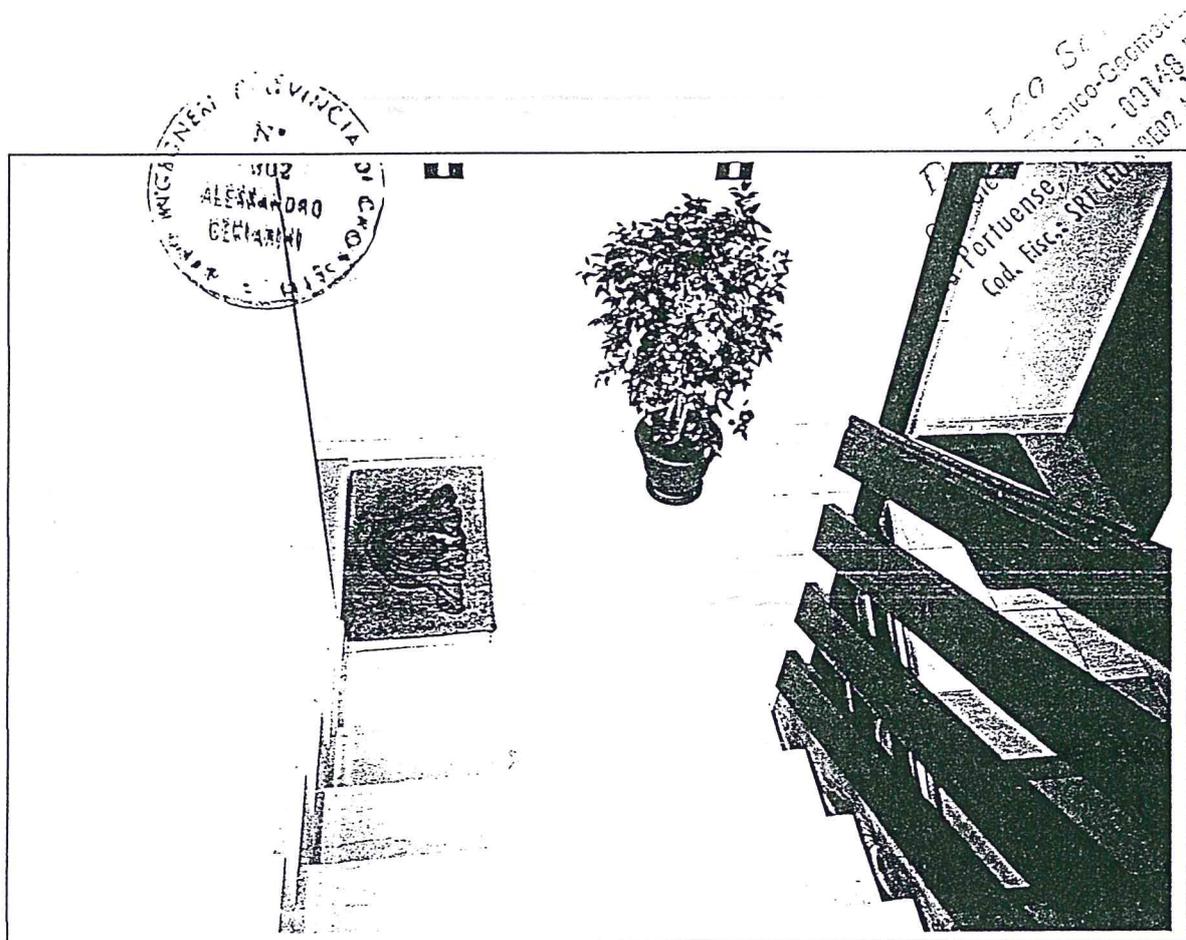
Pianerottolo delle scale con dettaglio sulla ringhiera in legno.
